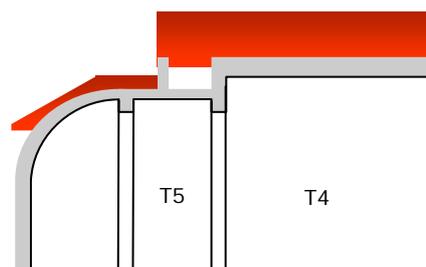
organisation des toitures T4/T5/chœur, coupe
